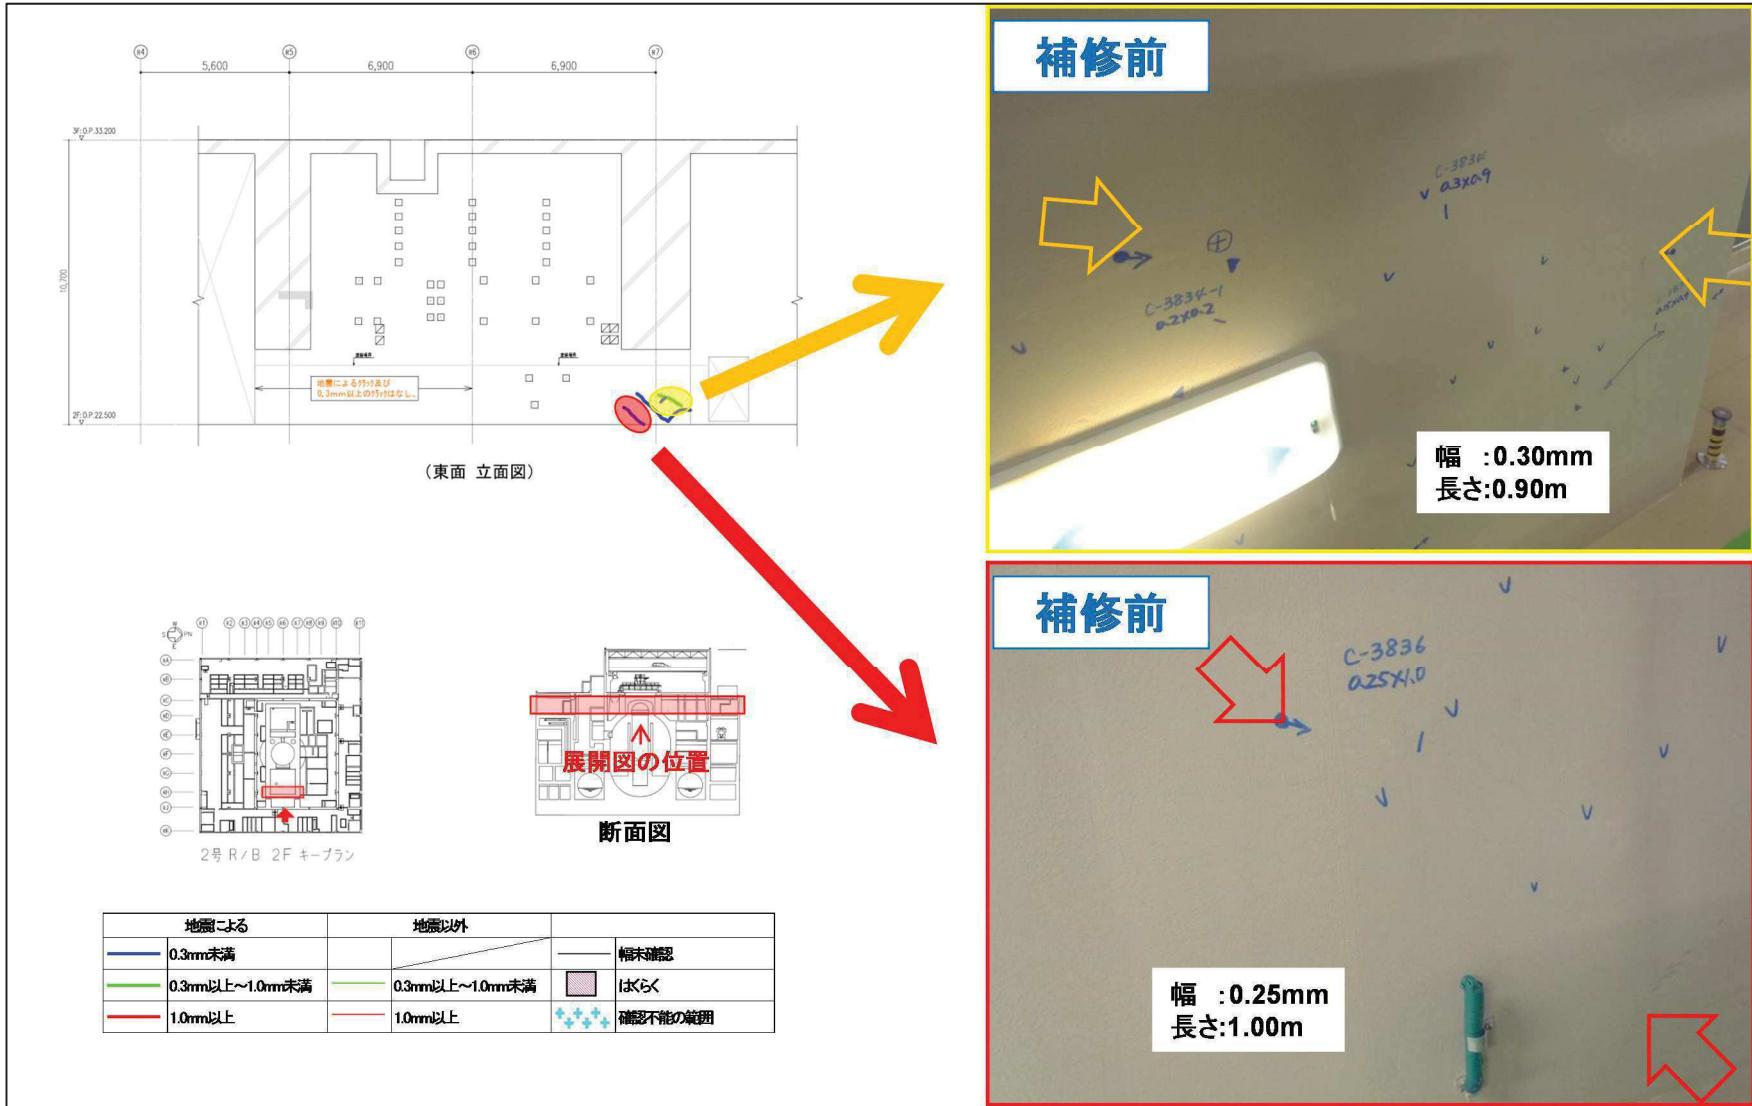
鉄筋コンクリート躯体のひび割れの例 (原子炉建屋地上 2 階)
